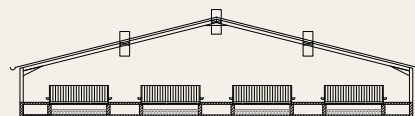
VUE EN COUPE D'UN BÂTIMENT TYPE TUNNELS DE VEAUX DE BOUCHERIE
